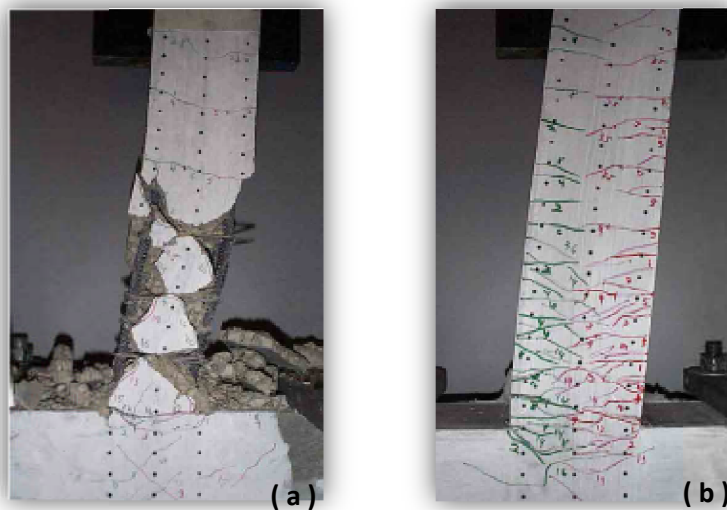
Comportamento ao dano: (a) concreto armado e (b) ECC armado sem estribos.
